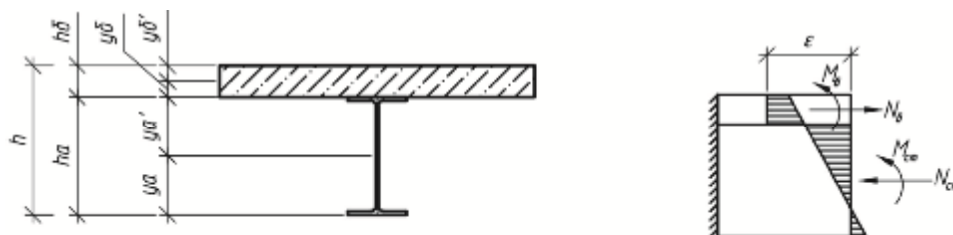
Поперечное сечение, эпюра напряжений, внутренние усилия
